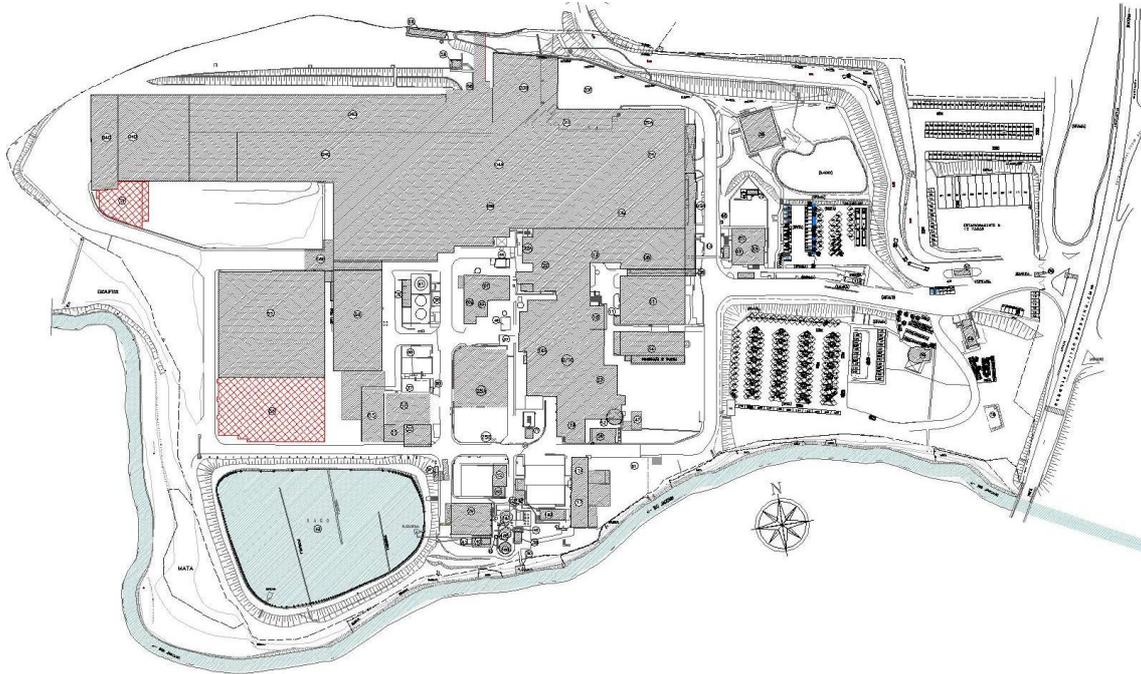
Implantação da fábrica com os prédios a serem construídos indicados em vermelho. No anexo 1 desse estudo está uma implantação em escala maior para melhor leitura.
